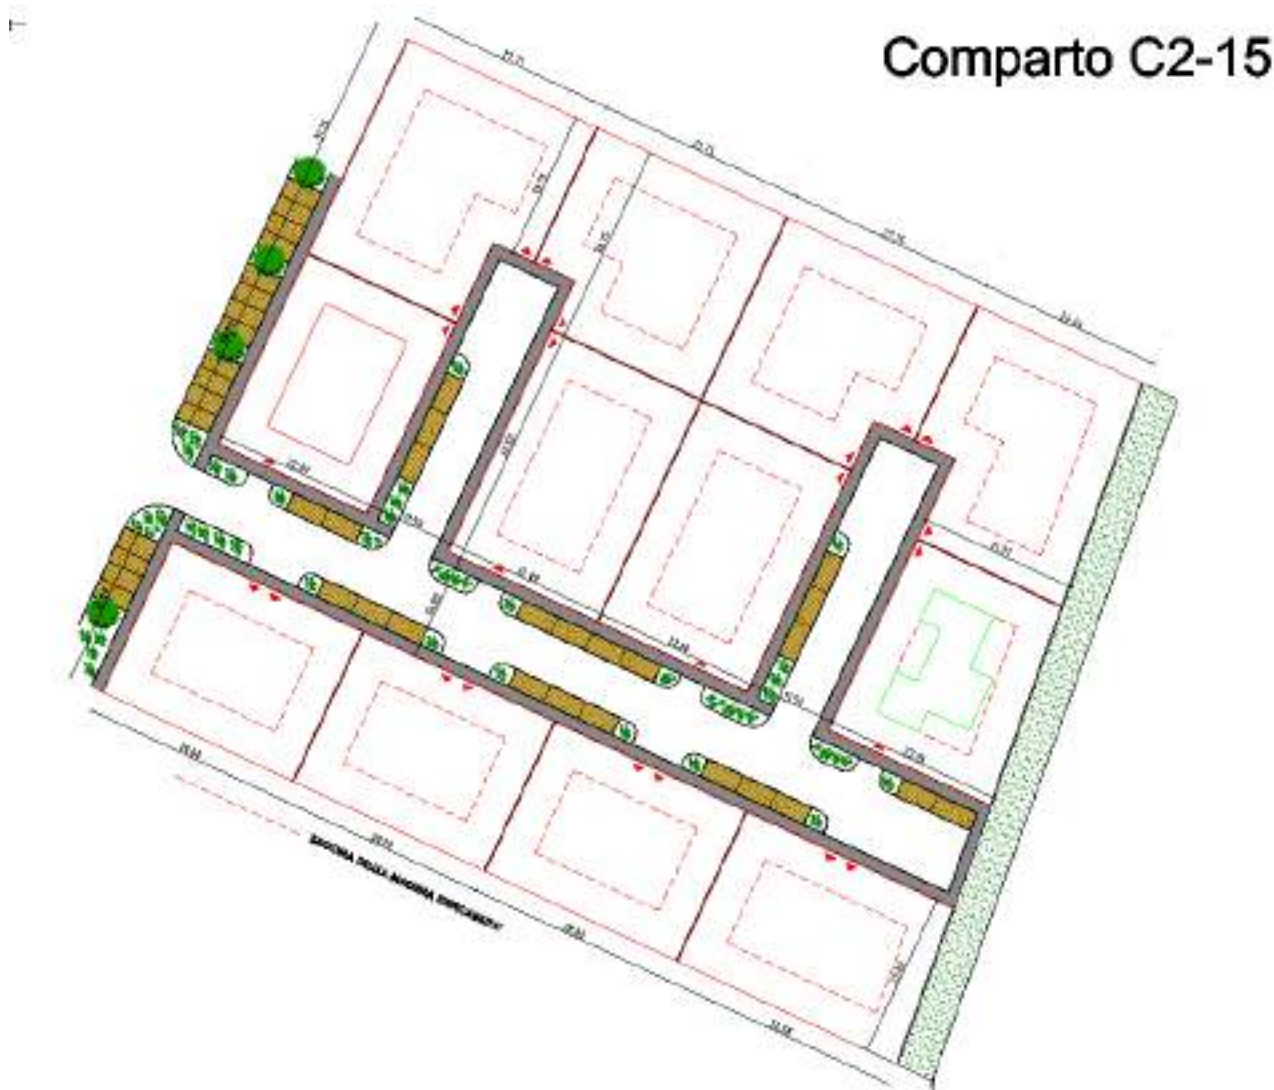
Estratto non in scala della Planimetria generale dell'area oggetto di studio.
